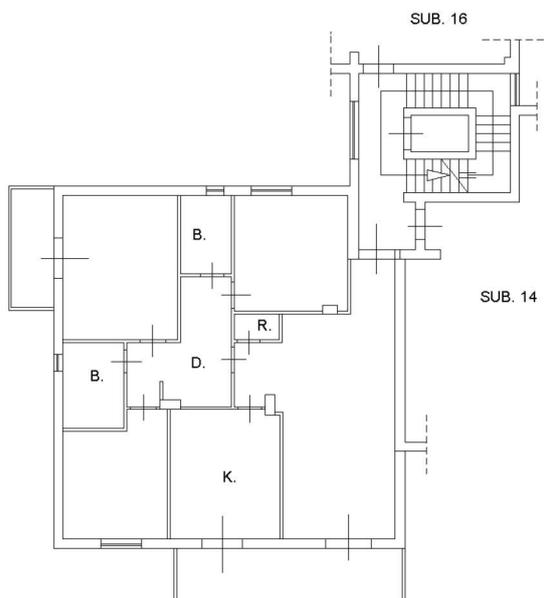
planimetria catastale dell'appartamento al quarto piano pignorato
